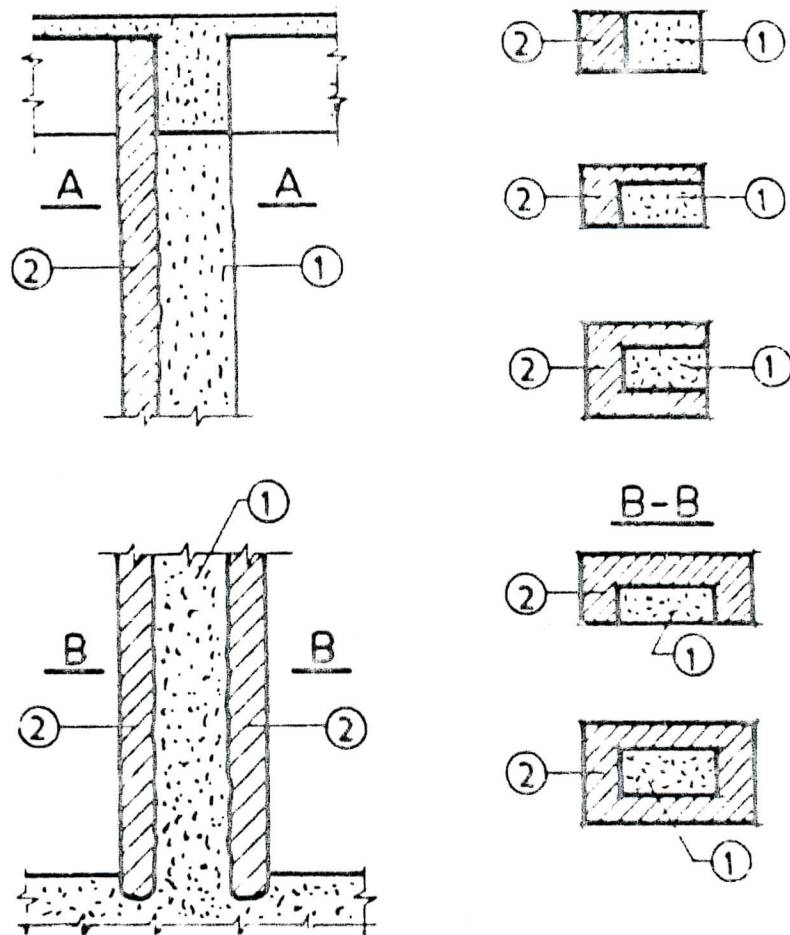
Gainage métallique avec augmentation de la section de béton* [4]
